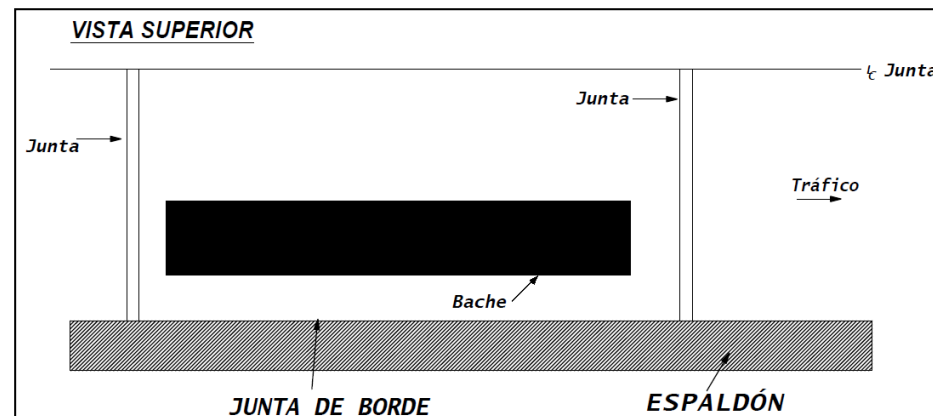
Esquema Baches mayores a 0,5 m<sup>2</sup> - Pavimento Rígido Continuo
